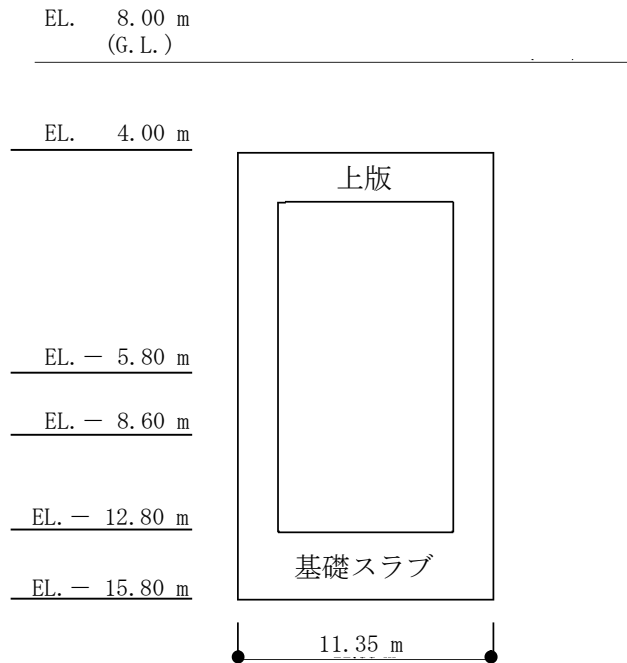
(2/2) 格納容器圧力逃がし装置格納槽の概略断面図 (B-B 断面)
